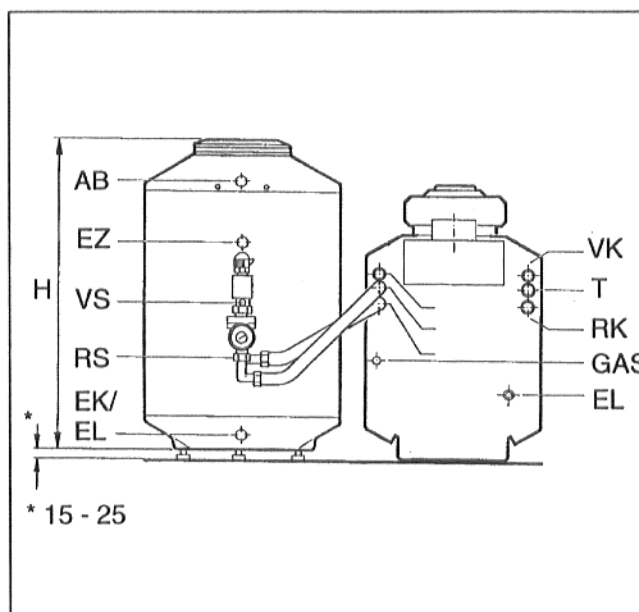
Vista posteriore; collegamenti dopo lo spostamento della guaina d'immersione e del tubo di collegamento per la mandata accumulatore
